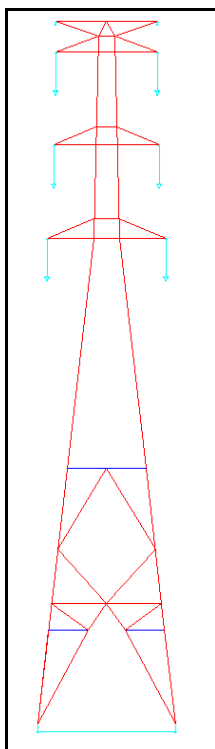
Silhuetas típicas das estruturas autoportantes que serão utilizadas na construção da LT 500 kV Manaus - Boa Vista e Subestações Associadas
